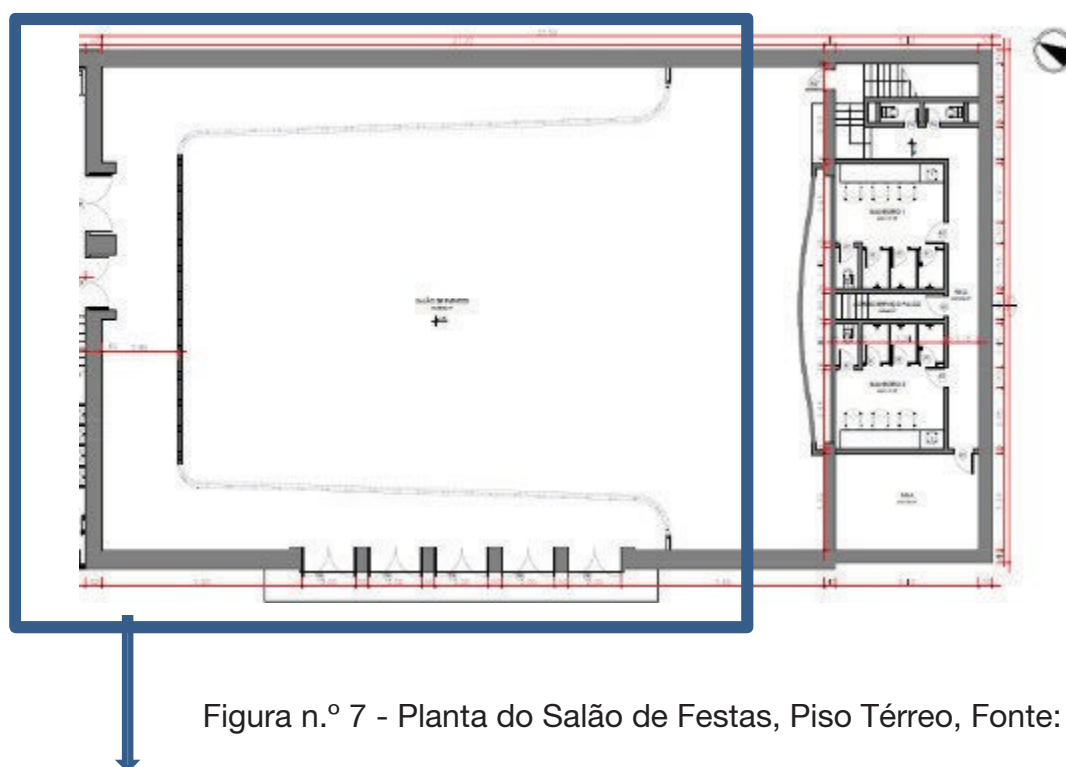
Planta do Salão de Festas, Piso Térreo, Fonte: SIRB
